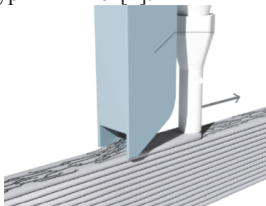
Схема армування конструкцій фіброволокнами при окремому укладанні фібри та бетону
